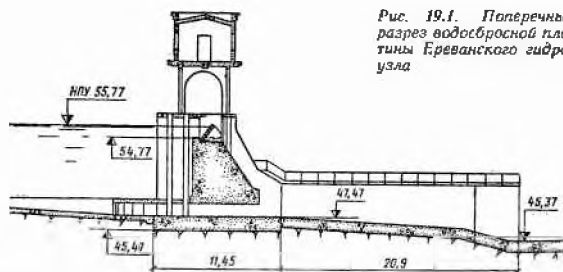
Поперечный разрез водосбросной плотины Ереванского гидроузла
